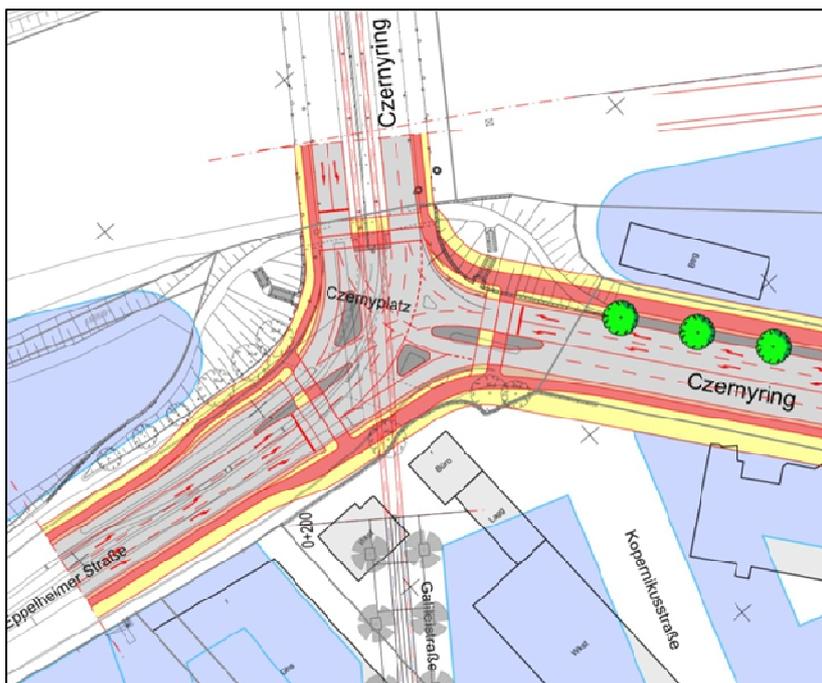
Lageplan K112 Czernybrücke, Variante 1-spuriger Linkseinbieger
